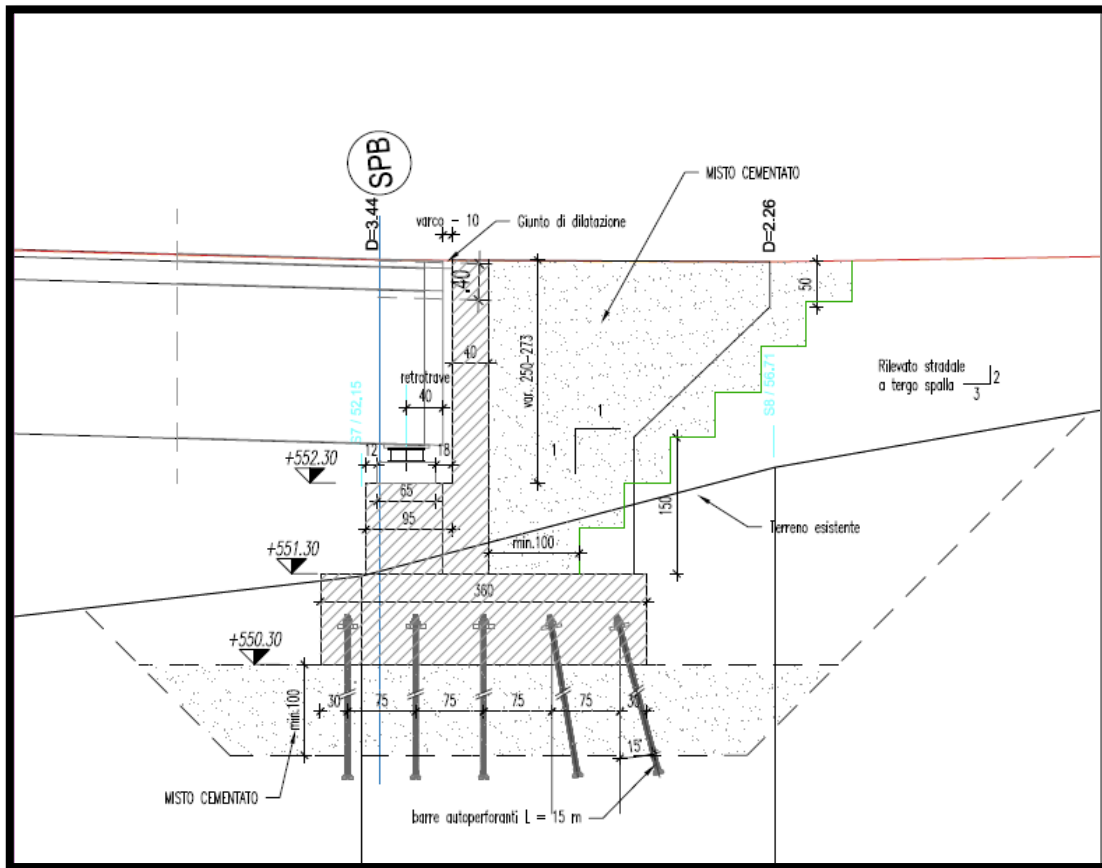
sezione della spalla B (spalla dx)
